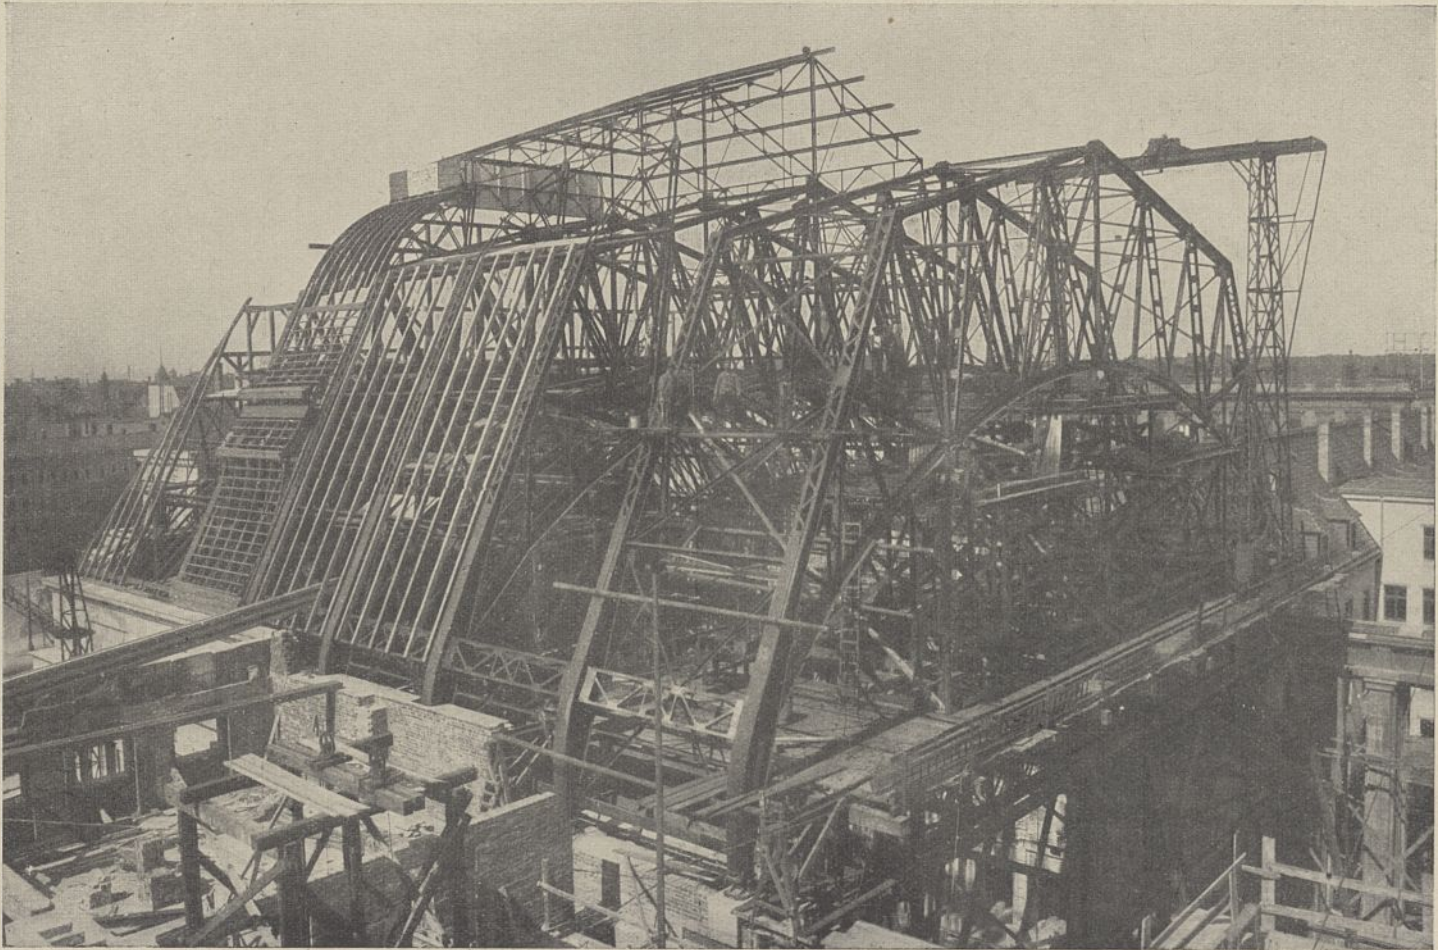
Westliche Eingangshalle, Dachkonstruktion, Bauzustand im Juli 1911.
